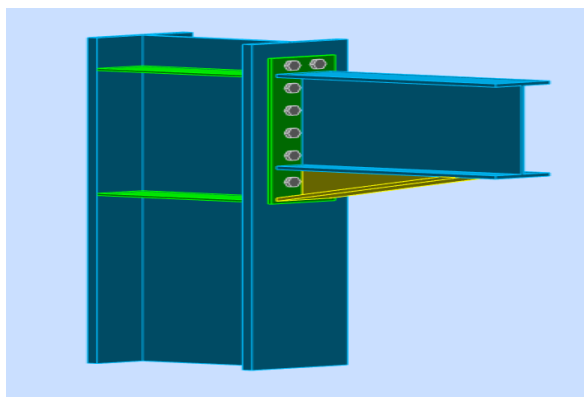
Schéma de l'assemblage poutre – poteau.
